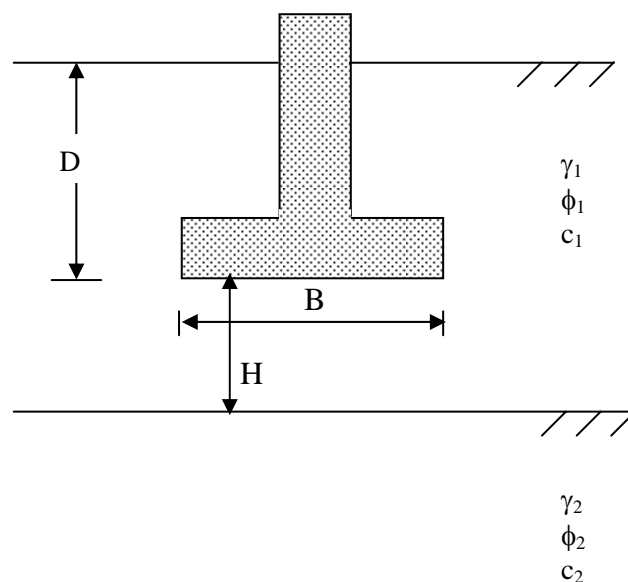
Fondation superficielle sur un sol bicouches [1].
